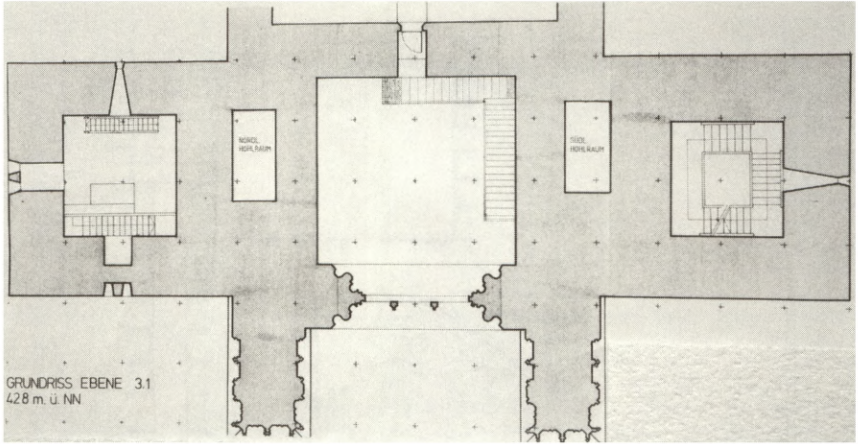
Grundriss der Westturmanlage auf der Höhe der Hohlräume
